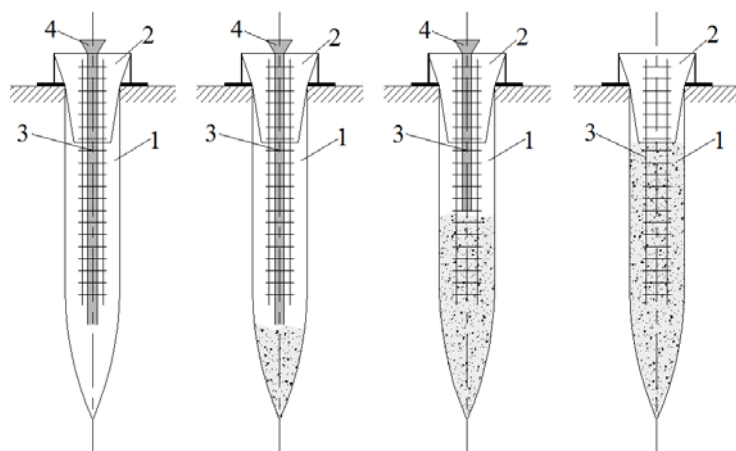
Схема бетонирования раскатанной скважины с помощью бетонолитной трубы: 1- скважина; 2- бетонолитная воронка; 3- арматурный каркас; 4- бетонолитная труба.
